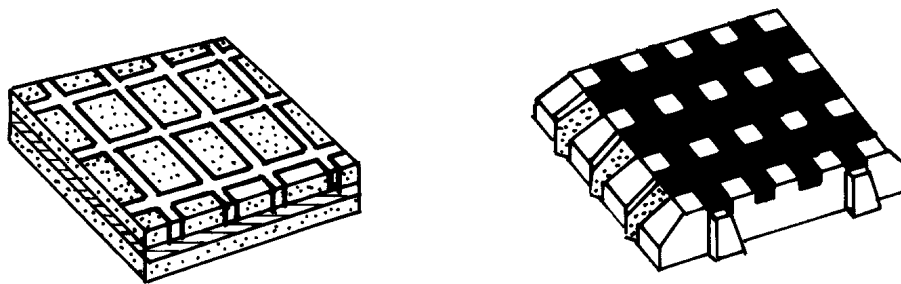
Pavimentos porosos (fonte: Urban Drainage and Flood District, 1992)
